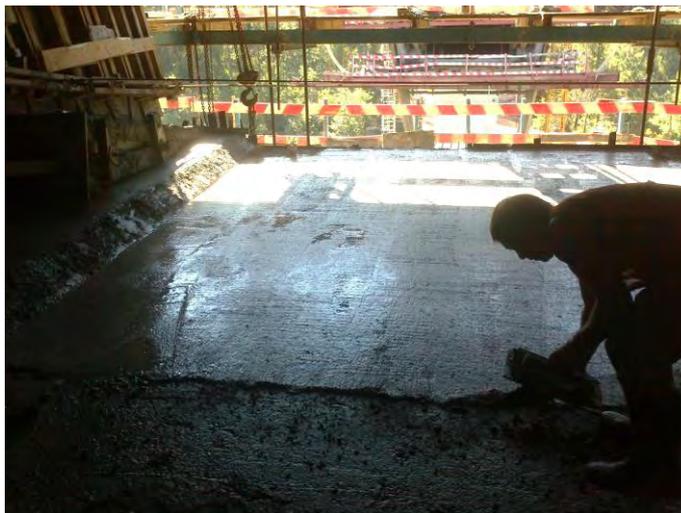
Acabamento de superfície do banzo inferior da viga caixão
